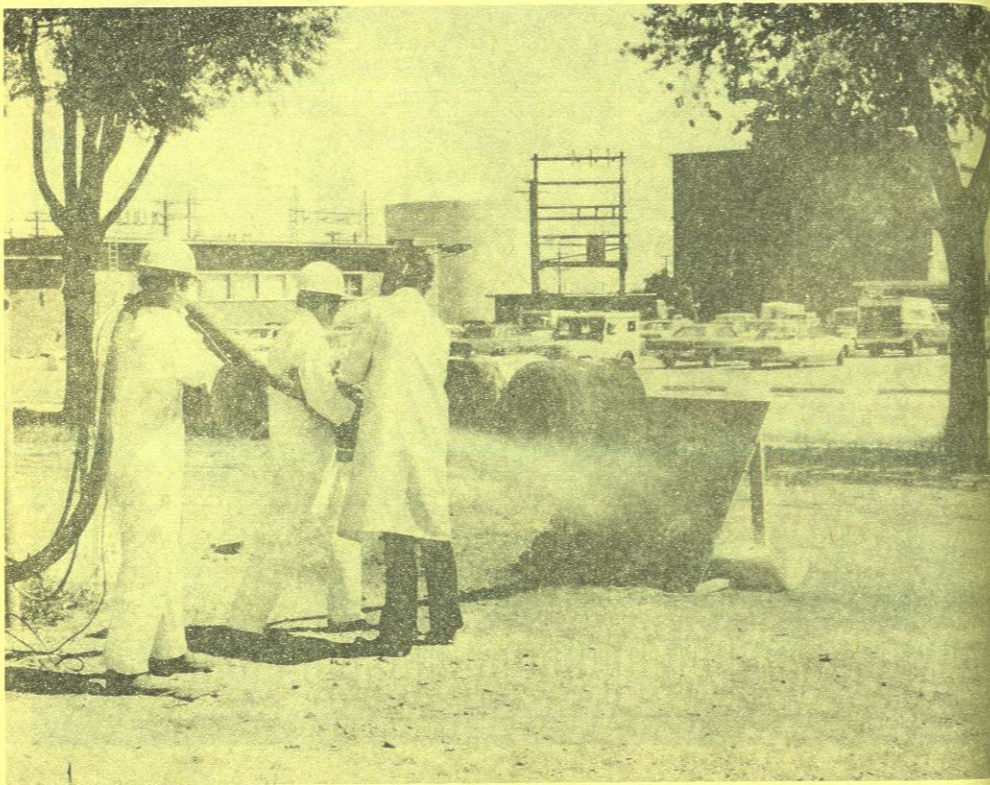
Ensayando la aplicación del concreto de polímero lanzado.
